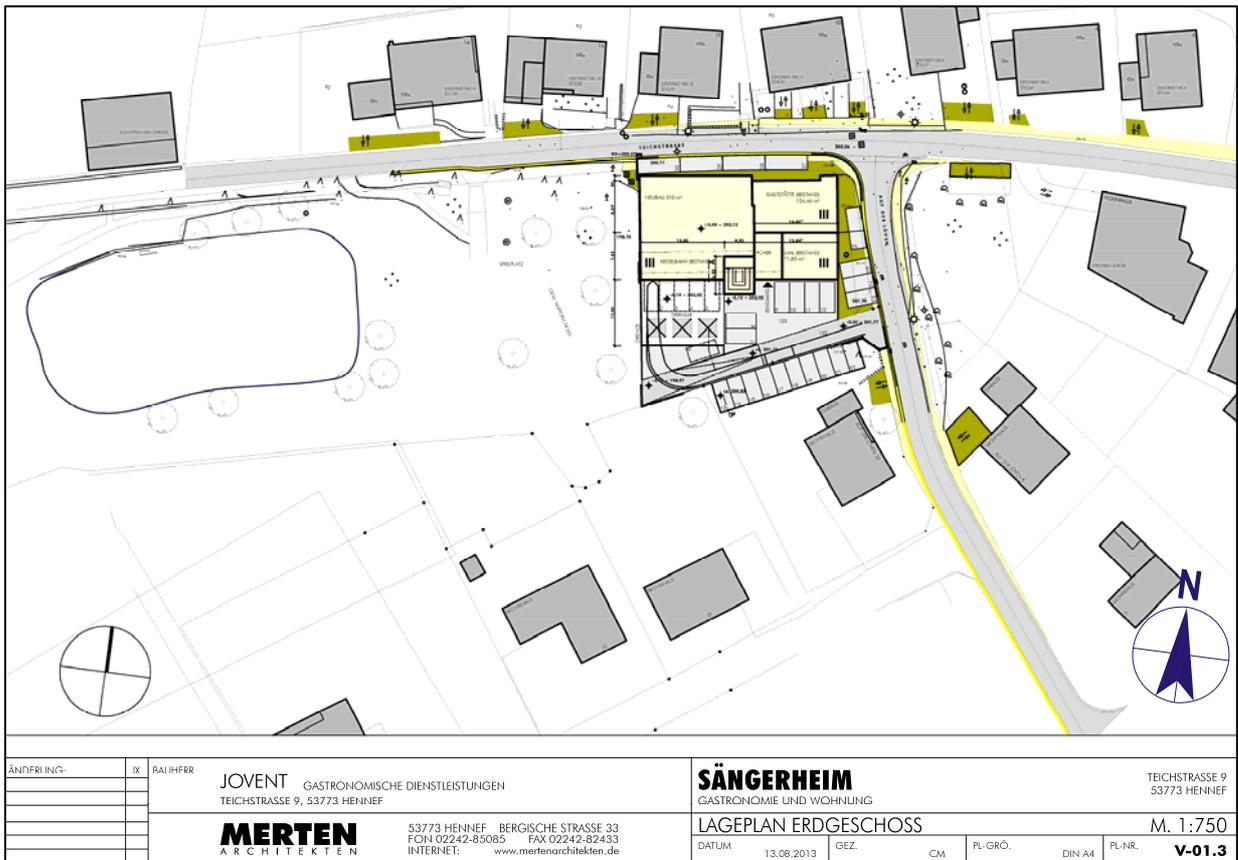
Erweiterung Sängerkheim, Lageplan EG, Maßstab 1:1.250
